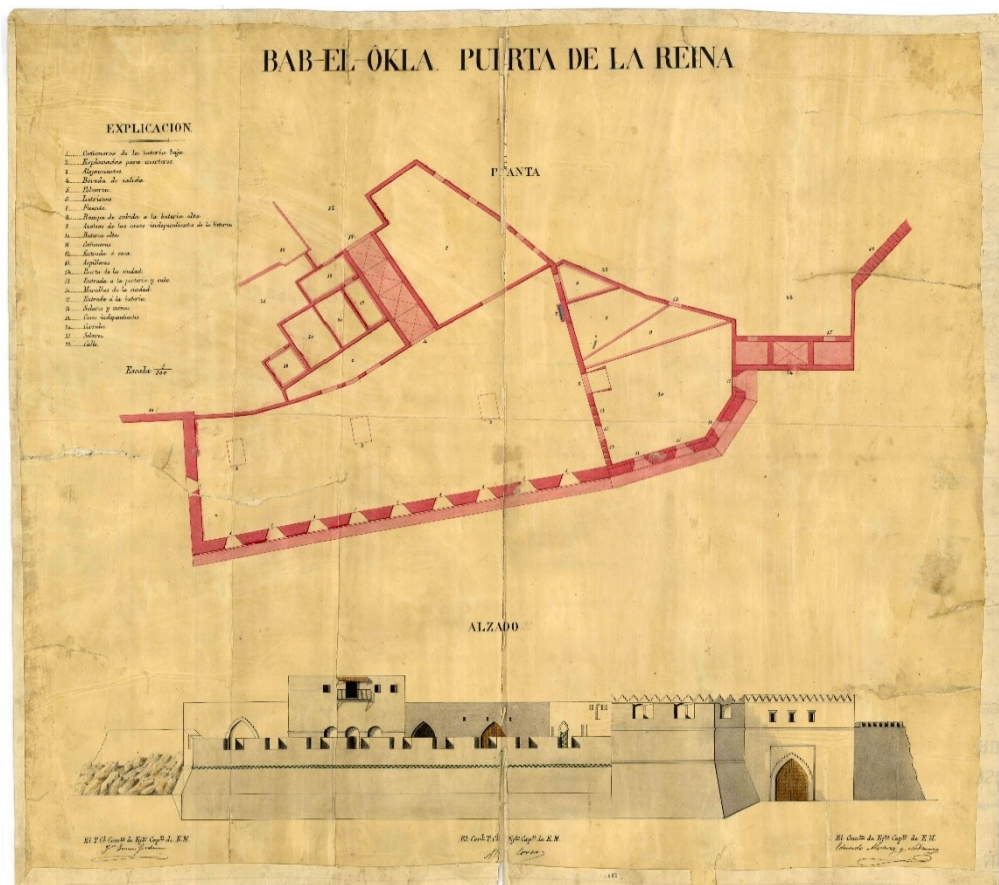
Planta y Alzado de Bab Oqla, 1888 (Fuente: Archivo del Servicio Geográfico del Ejército, Madrid)³
